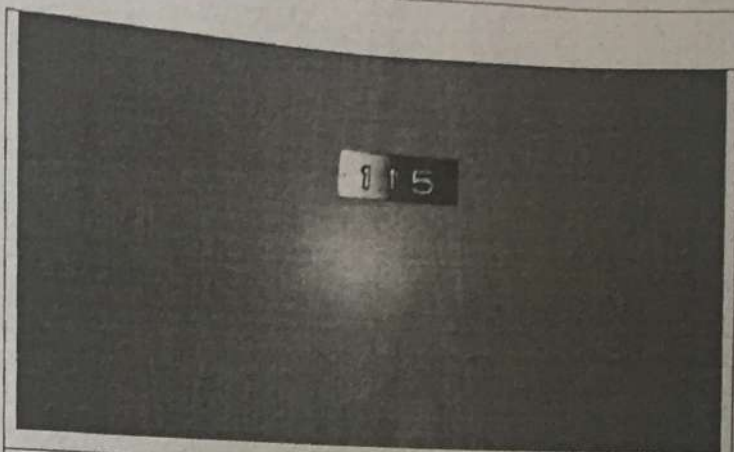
Detalhe da porta do Apartamento Nº 115.
